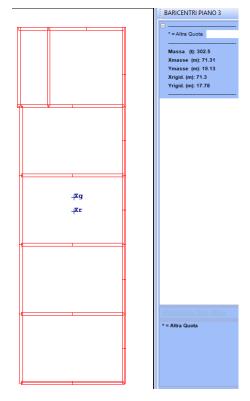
Baricentro masse e baricentro rigidezze piano terzo (piano n°3)
